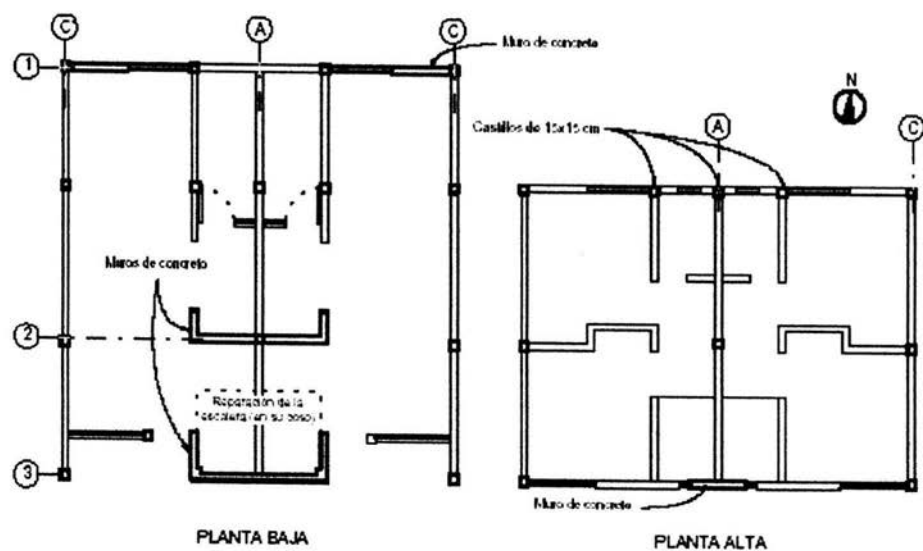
A) Disposición del daño en la planta baja de la vivienda. B) Esquema de rehabilitación reemplazando muros de mampostería dañados y adicionando muros de concreto y castillos (ver ref.6).
